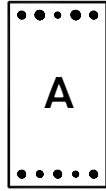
repetida : Armadura principal y secciones en vigas.
